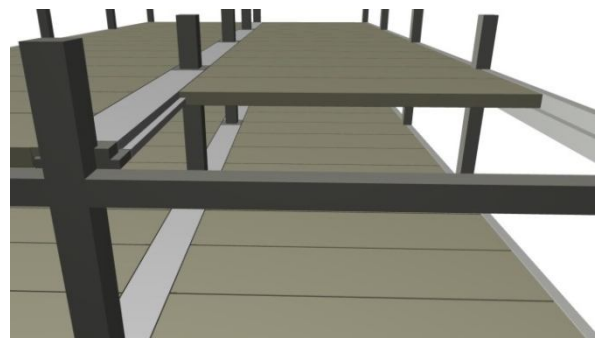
Загальний вигляд збірного перекриття з модифікованими круглопустотними плитами / General view of the precast flooring slabs with modified
